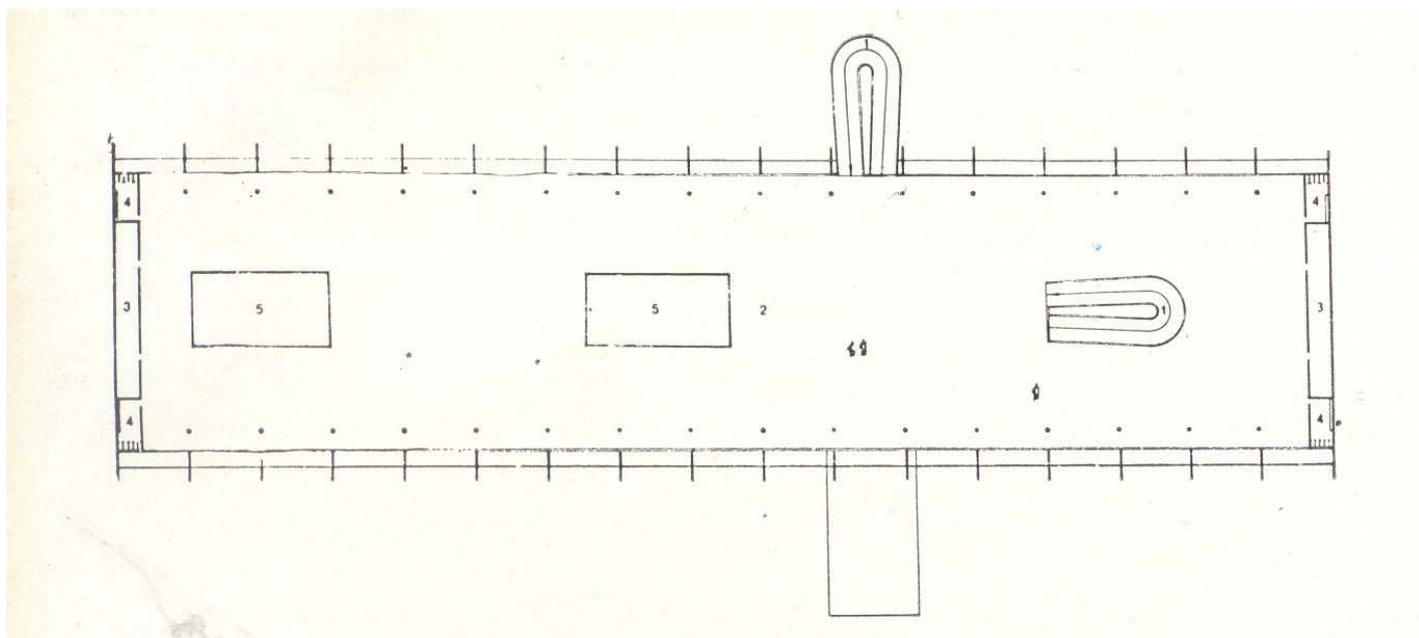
Planta do Pavilhão das Indústrias, primeira versão do projeto. Fonte: Revista Módulo, ano 1, nº 1, 1955.
